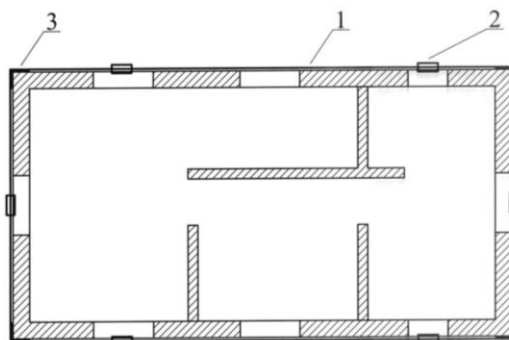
Восстановление пространственной жесткости (устойчивости) здания стальными поясами, расположенными в уровне перекрытий:
